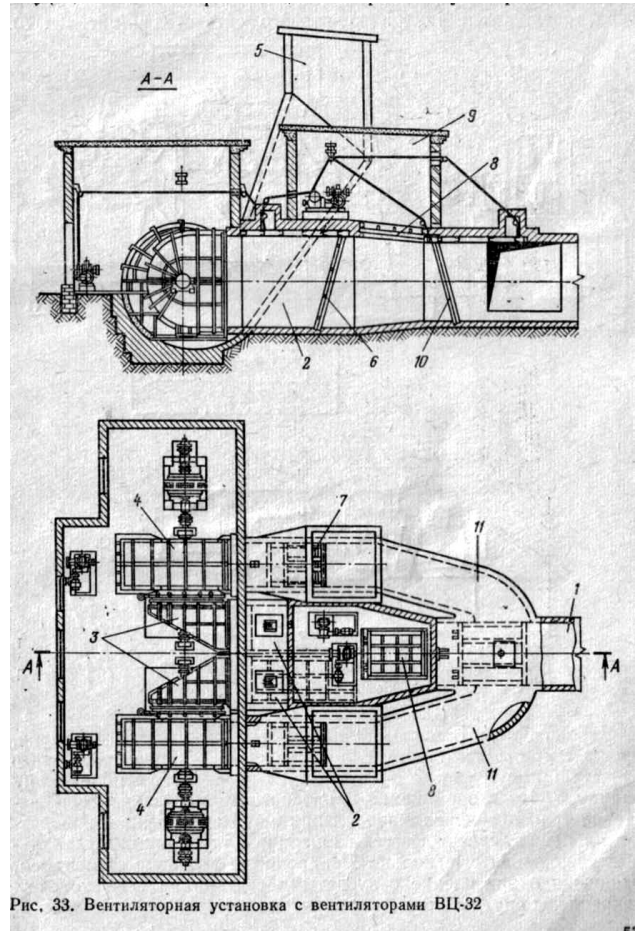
Вентиляторная установка с вентиляторами ВЦ-32
